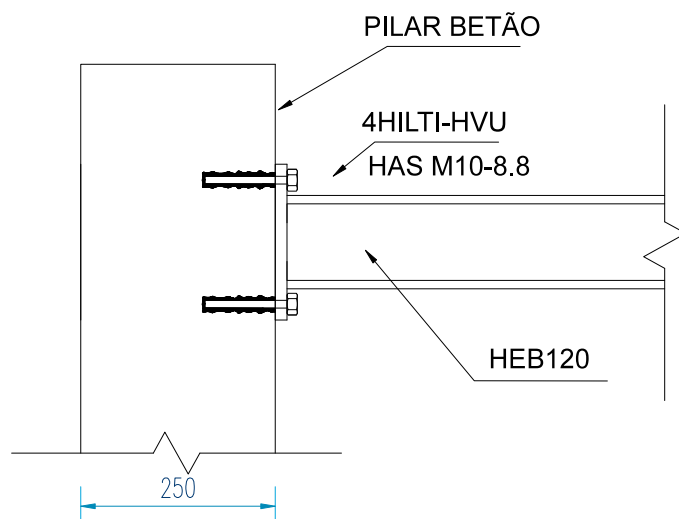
Vista lateral de ligação metálica do perfil no pilar de betão armado
